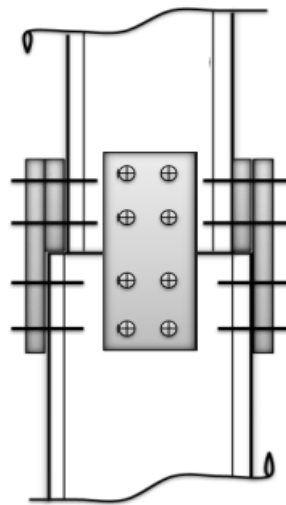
Assemblage poteau-poteau a section égale et section différente.
